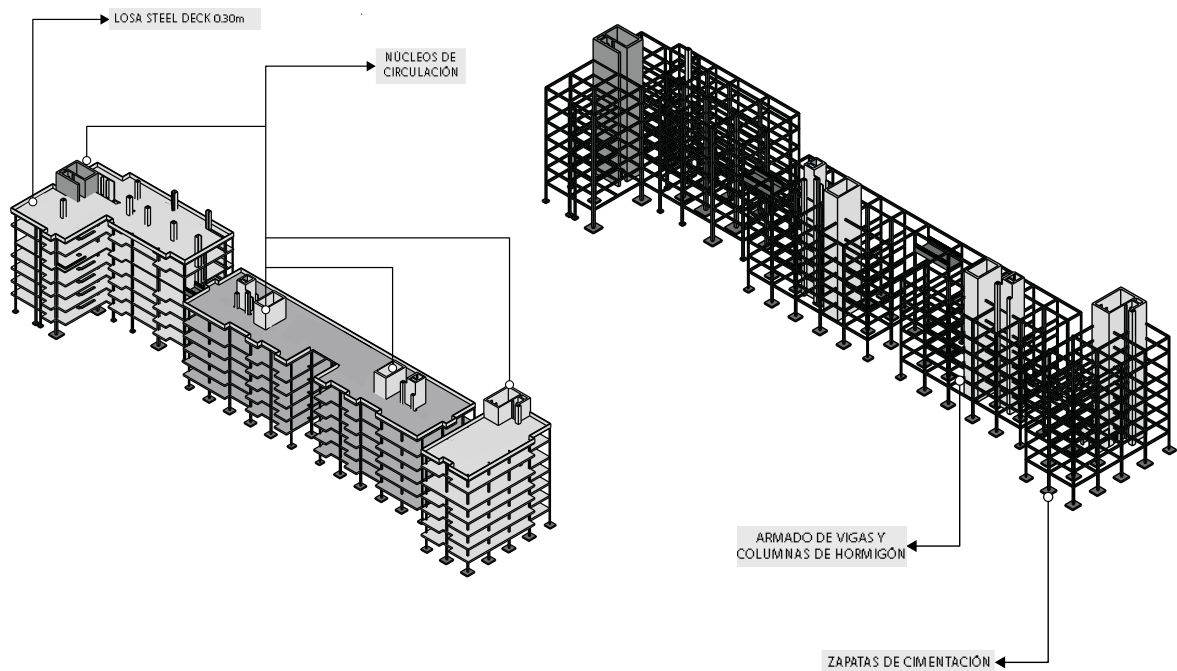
Sistema Estructural *Elaboración: Propia, 2021
